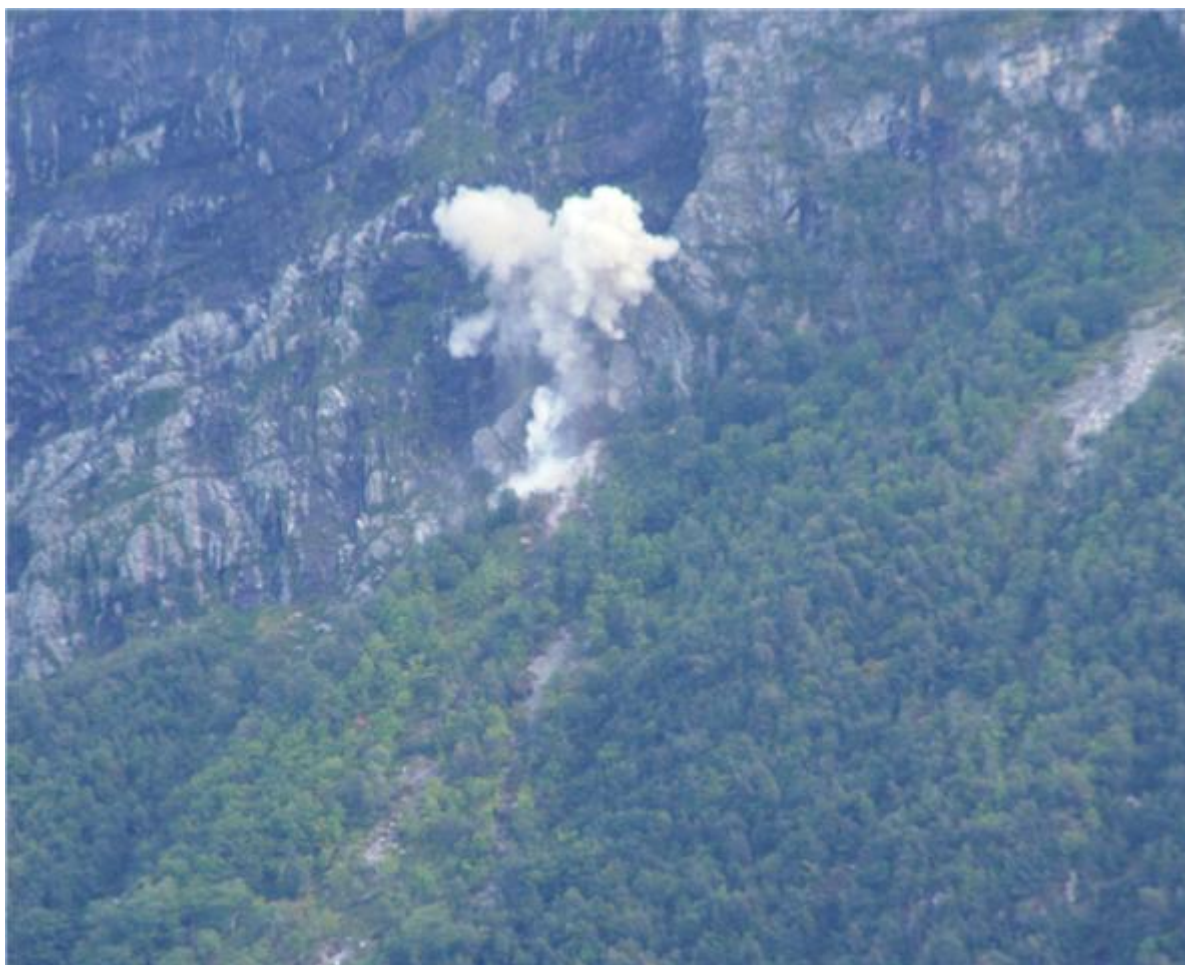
C6-1, etter sprengning (foto: Betongrenovering)
